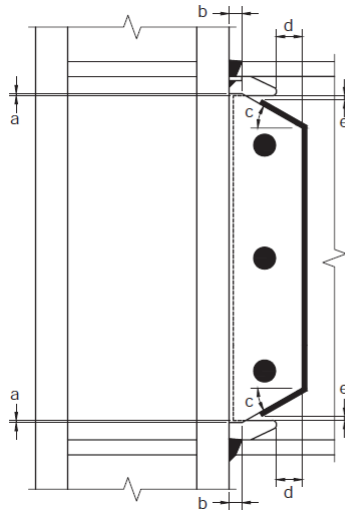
Detalles parte superior e inferior placa de corte.
